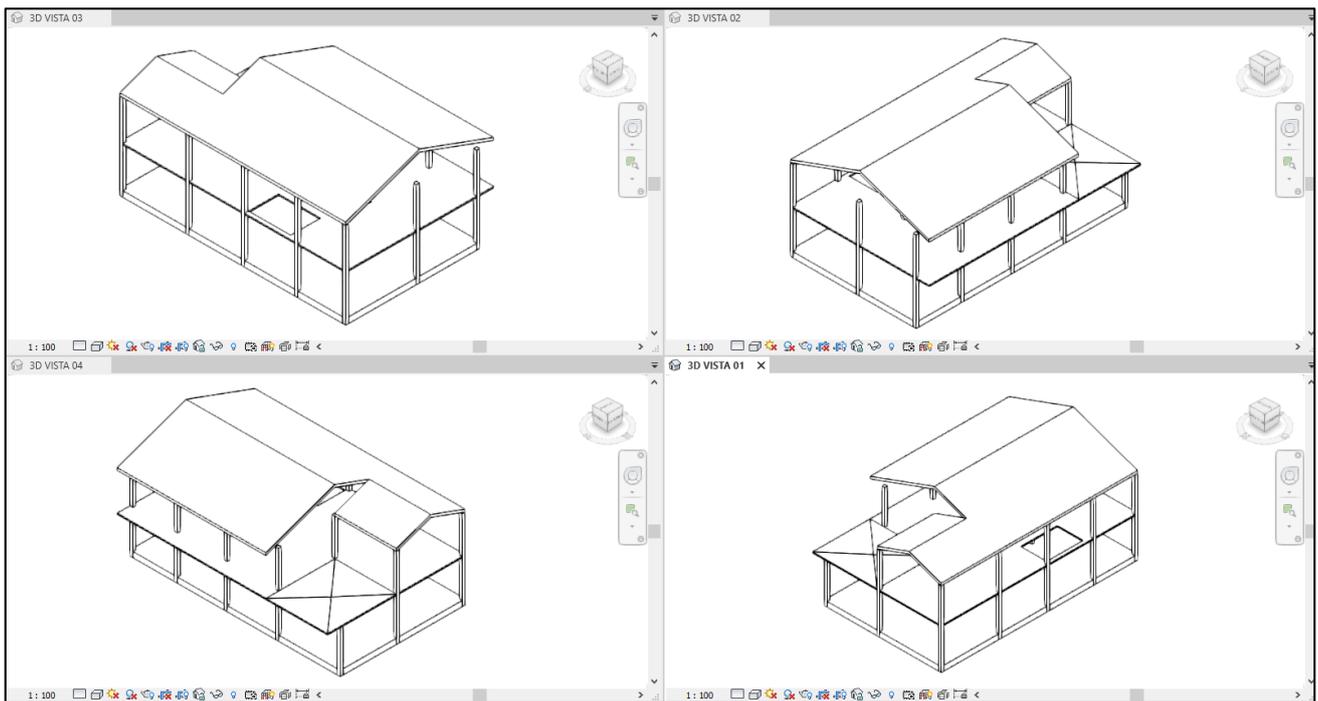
16. Recorte de pantalla, Vistas 3D
